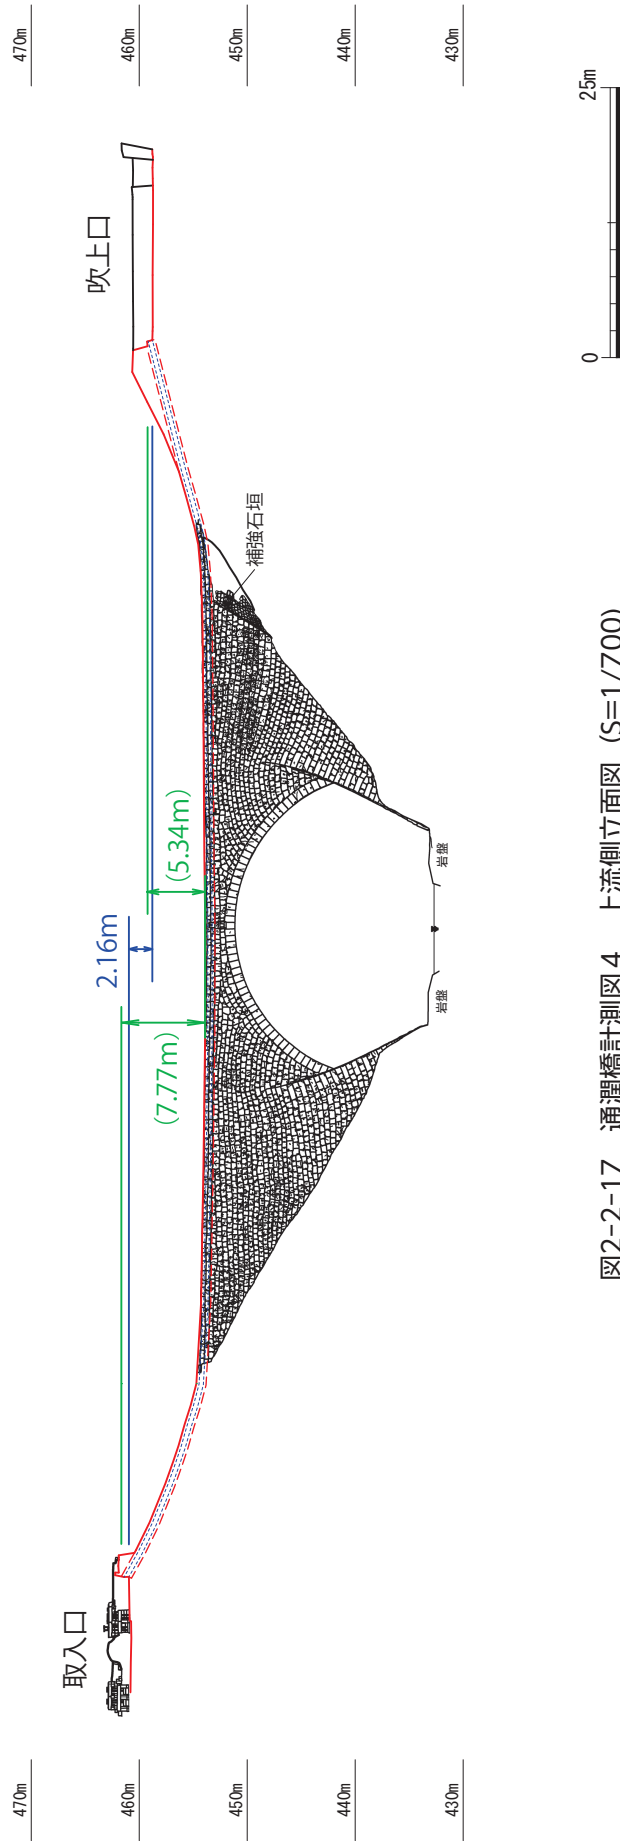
通潤橋計測図4 上流側立面図 (S=1/700)
